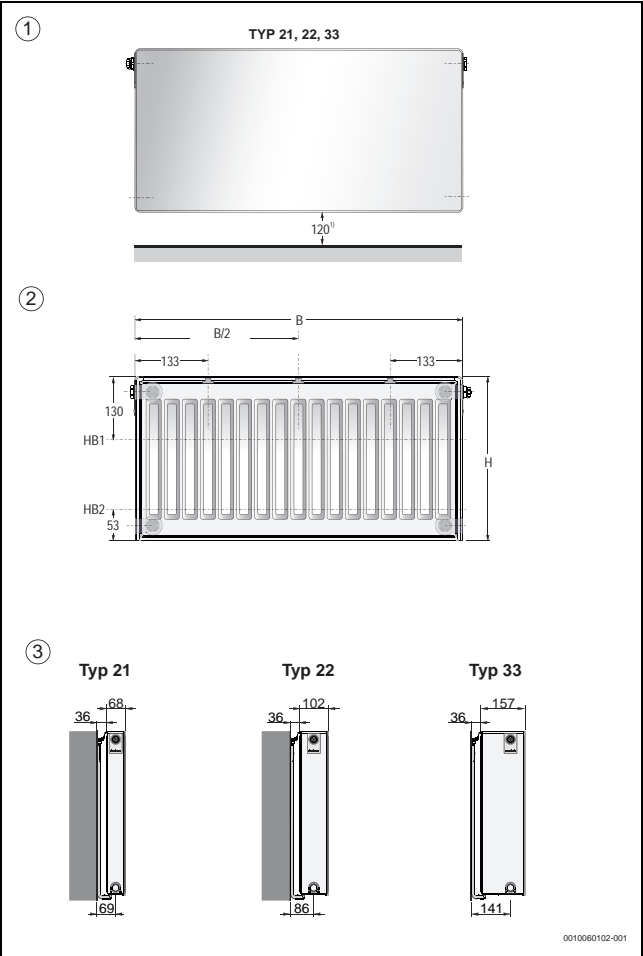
Abmessungen der Flachheizkörper Logatrend A-Plan.2 (Maße in mm)
